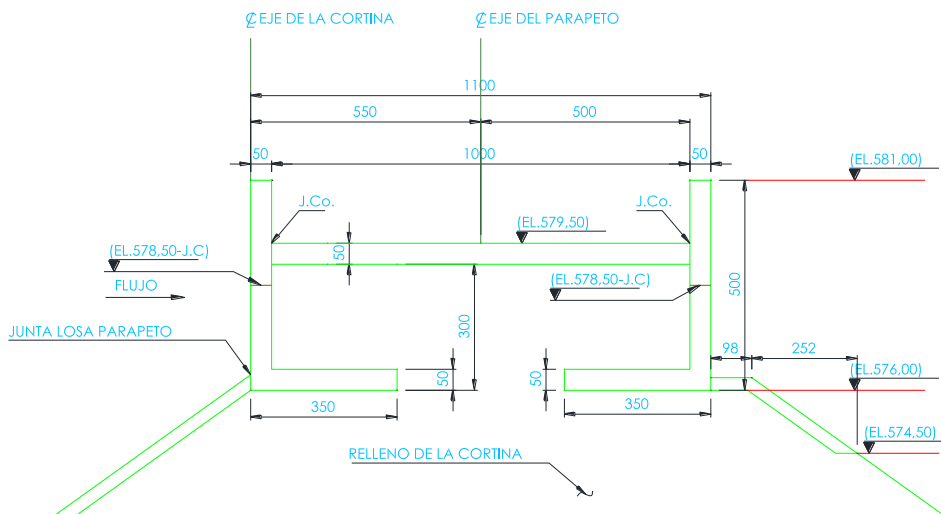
Sección Transversal Muros parapeto en los estribos de la Presa La Yesca
